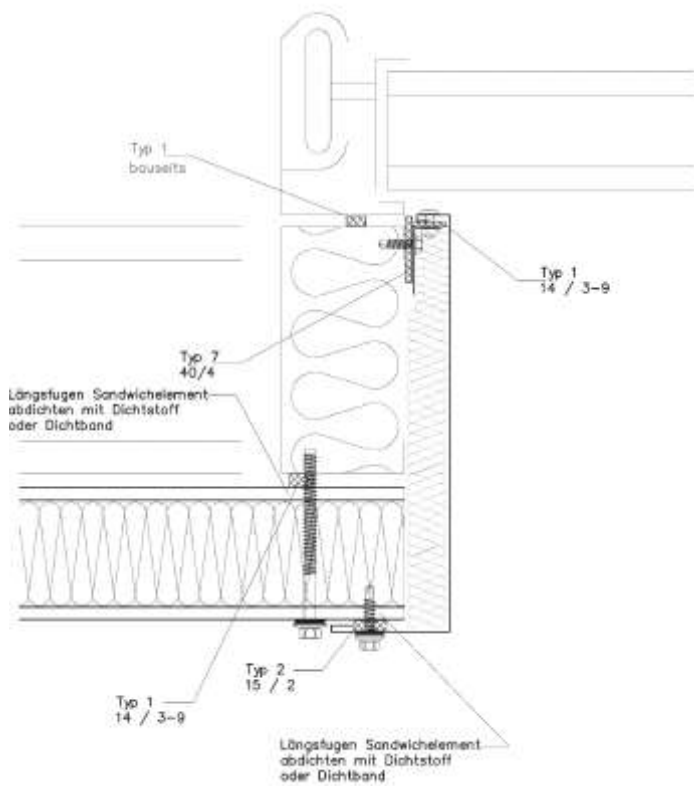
Bovenaansluiting poort – verticale snede.⁴⁰
